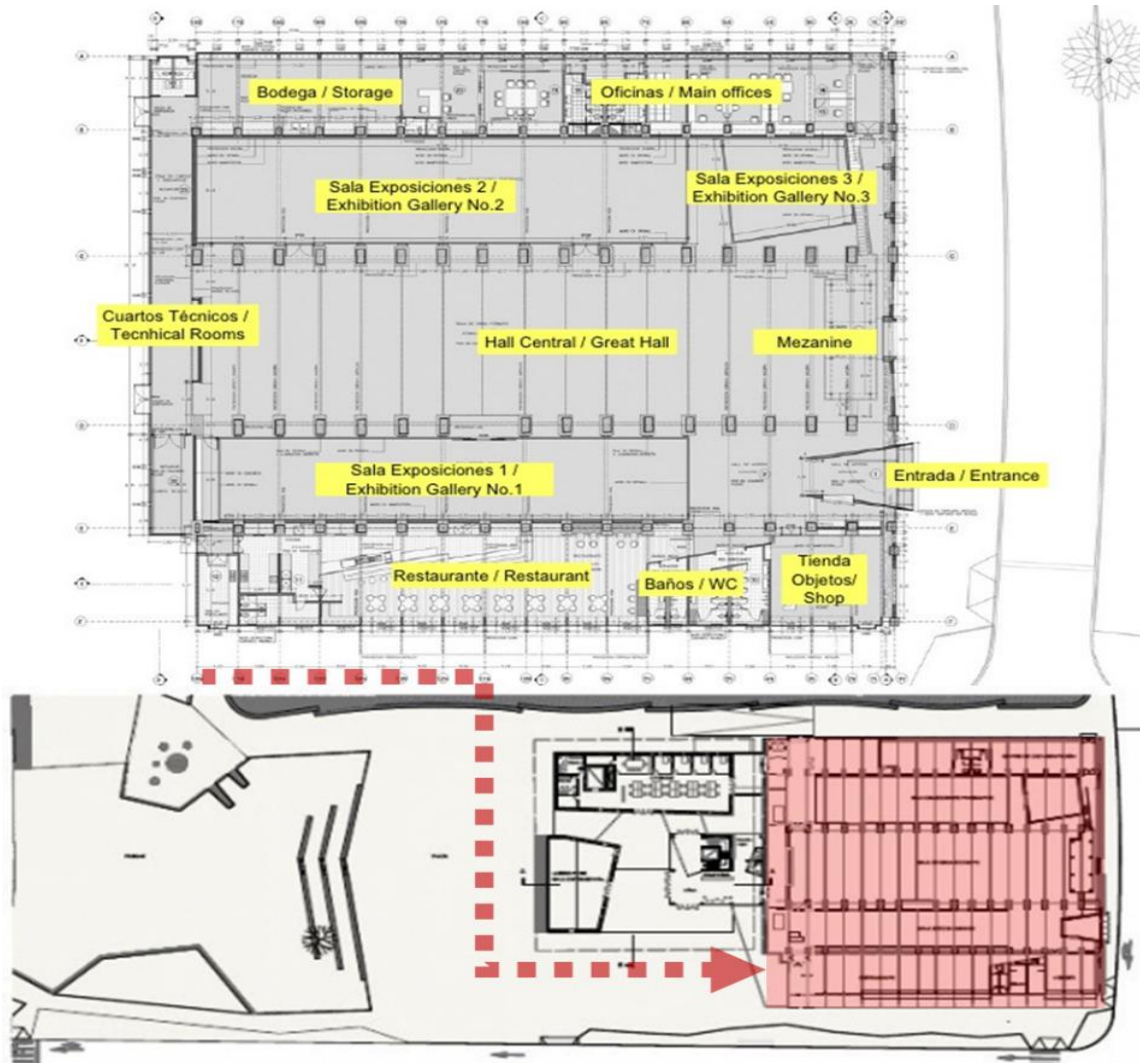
Primera planta del Museo de Arte Moderno Medellín
